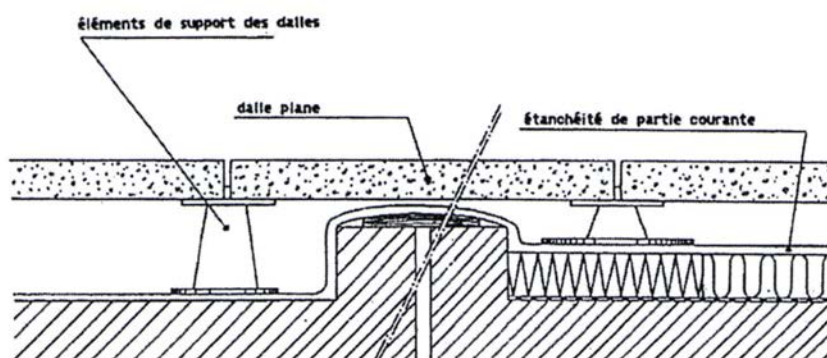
Protection des joints sur costières en toitures accessibles aux piétons et au séjour protégées par dalles sur plots (ex. avec et sans isolant)
